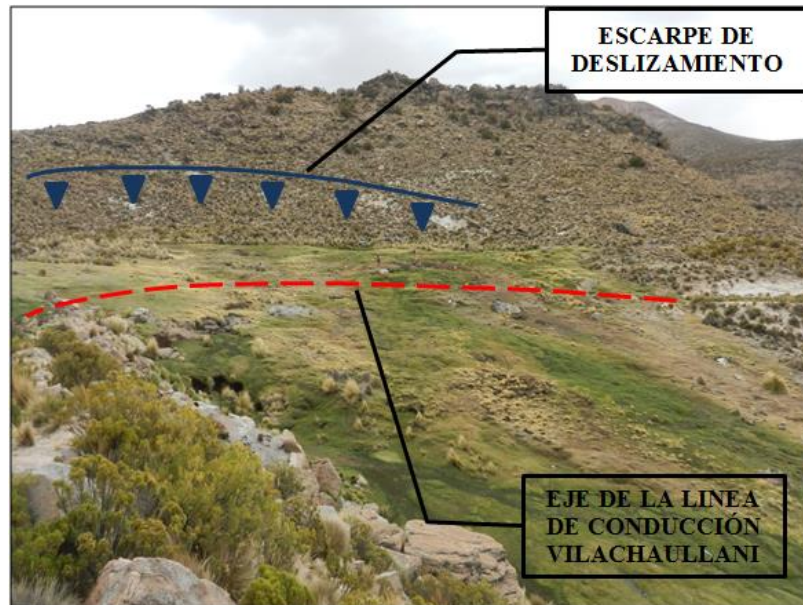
Vista de deslizamiento donde se emplazará la línea de conducción. Elaboración propia.
